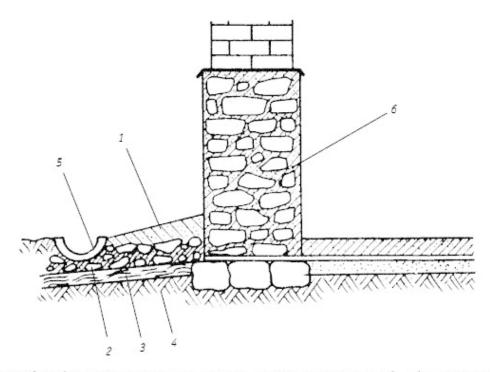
Столбчатый фундамент для печи: 1 — цементный раствор; 2 — битый кирпич или щебень; 3 — глина; 4 — грунт; 5 — водосточная канавка; 6 — фундамент
